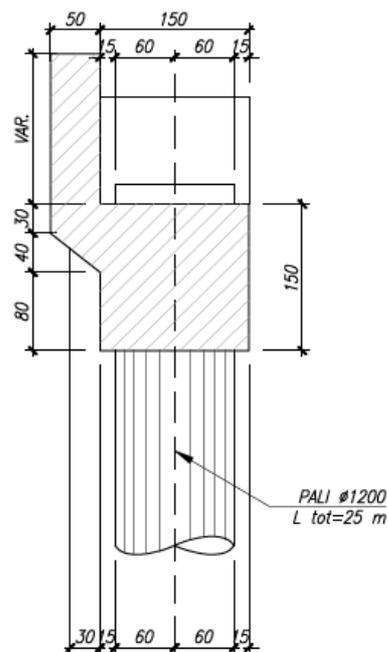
Sezione trasversale Spalle (Sezione A-A)
